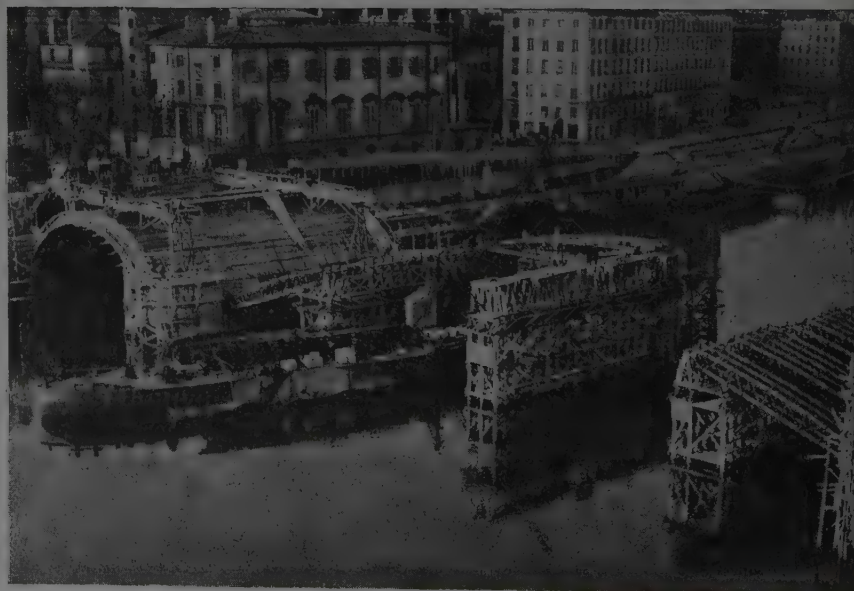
Pont Tilsitt. Mise en place au derrick de poutres en ventre de poisson sur passe marinière.
